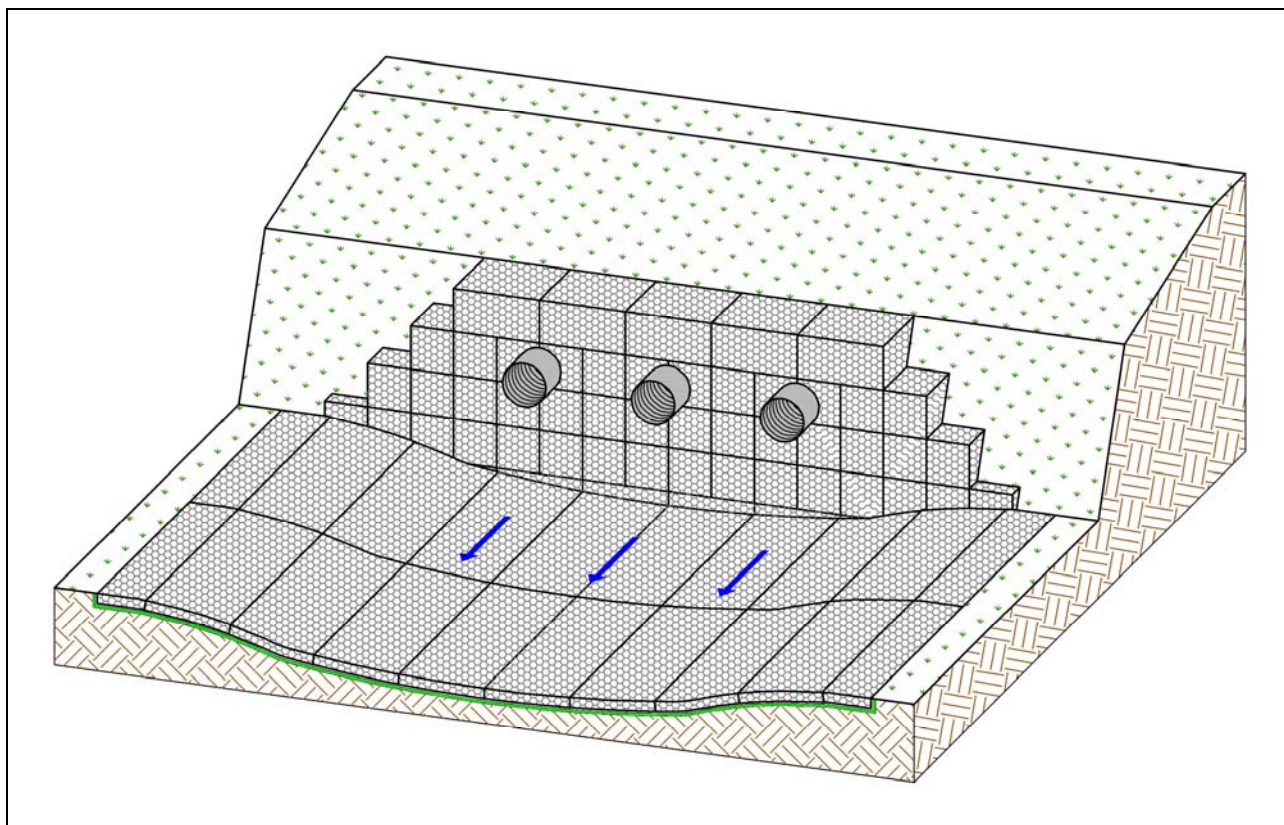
(продолжение) Укрепление оголовков водопропускных труб габрионными конструкциями
